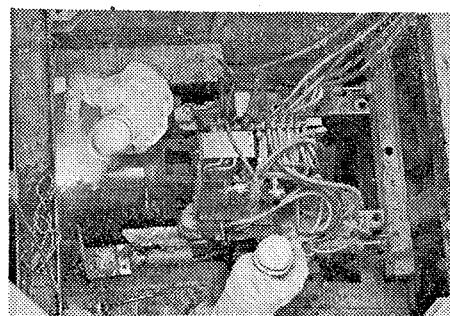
ケーシング溶接作業 (施工例 1)
